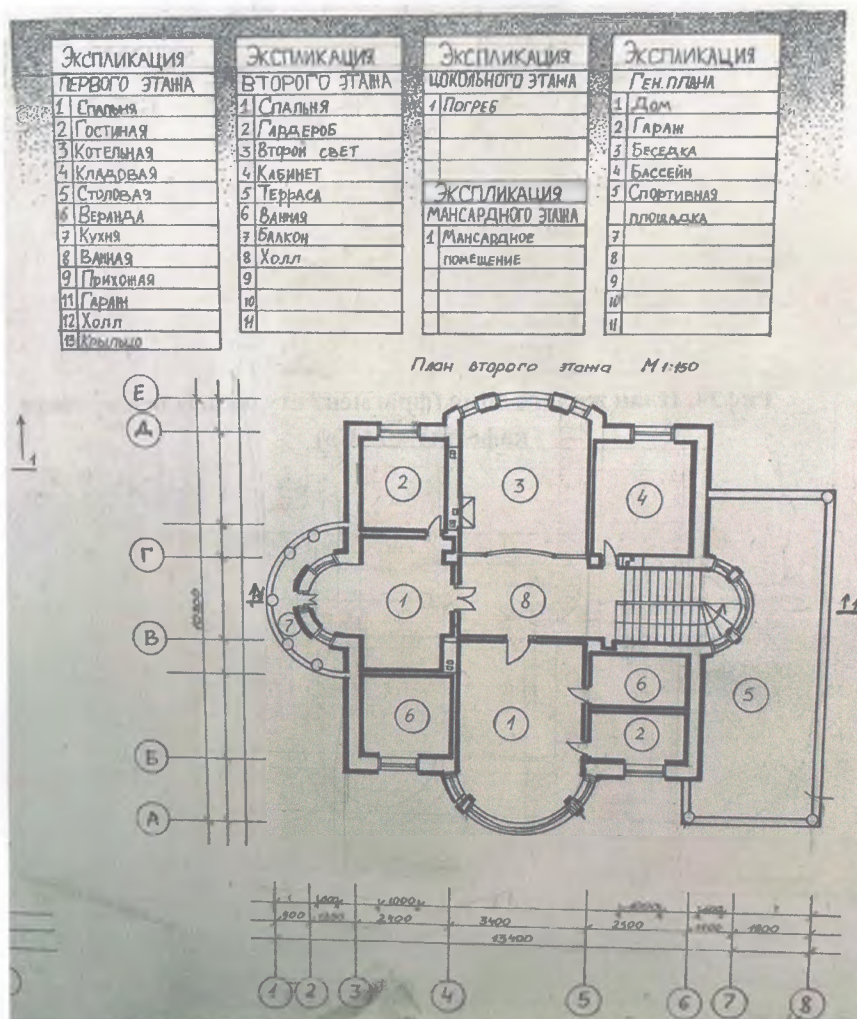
План жилого дома (фрагмент проекта студента гр. ДАС-3-14
